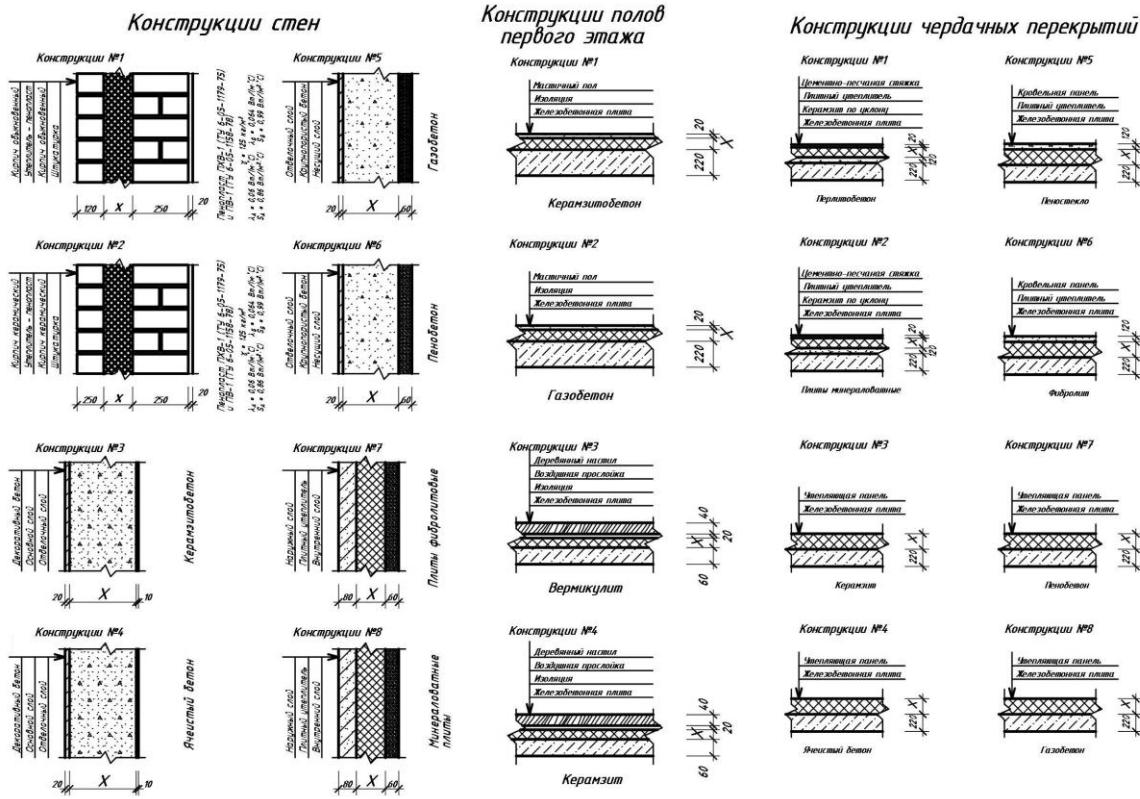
Конструкции ограждения (стен, полов первого этажа, чердачных перекрытий)
